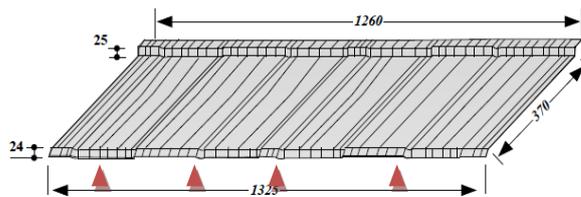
tuile METROTILE® WOODSHAKE - pose des fixations
